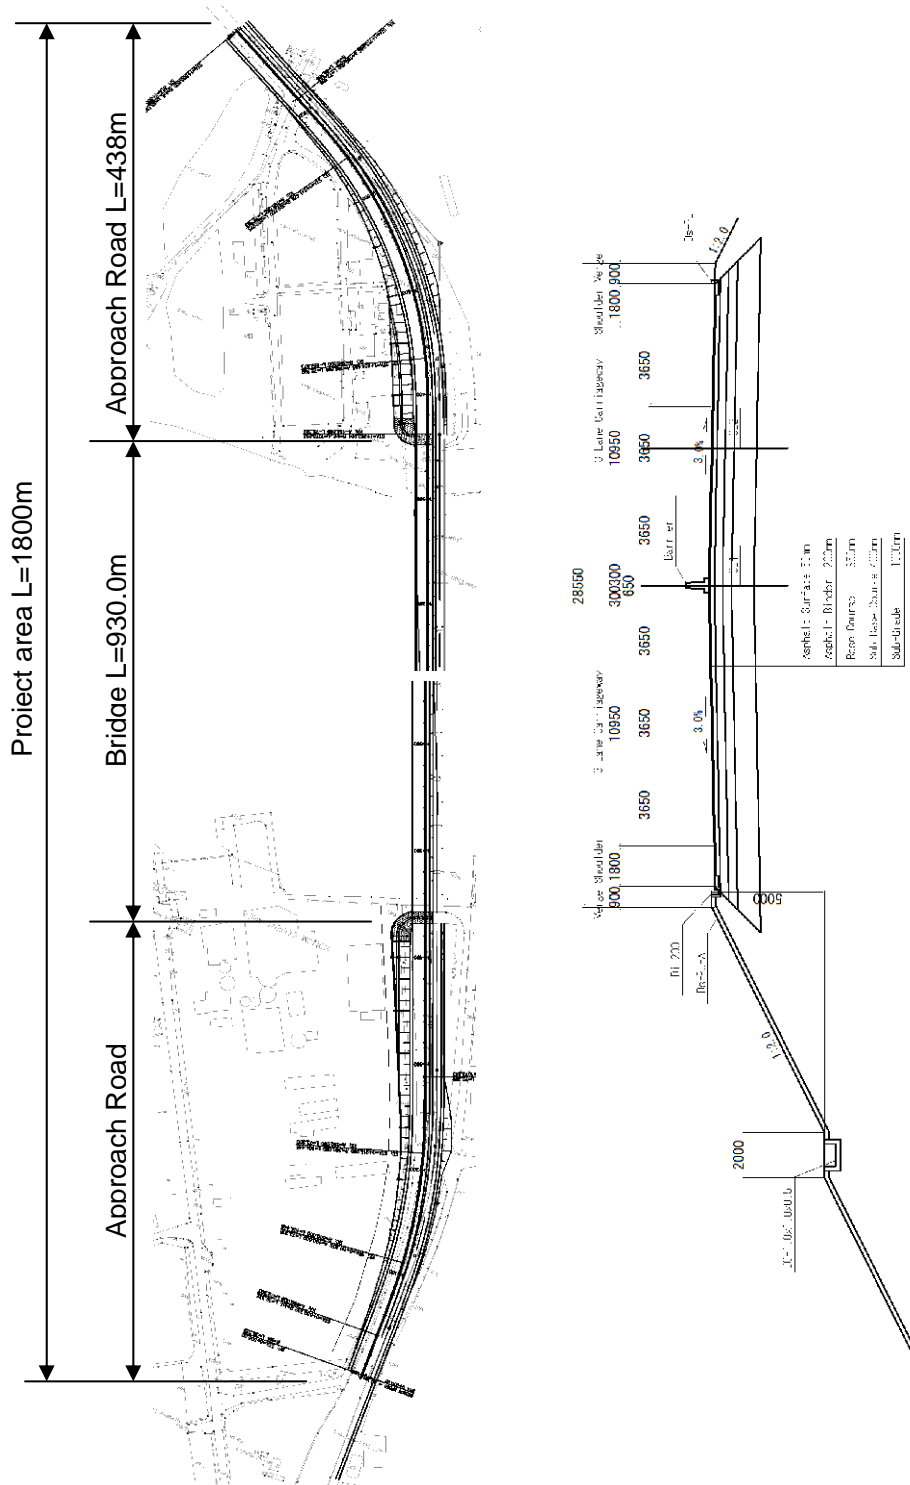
平面図、標準横断図 (第 2 メグナ橋)
